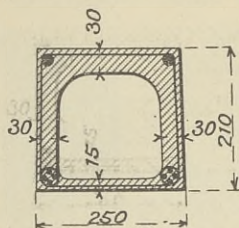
Coupe d'une poutre creuse, système Siegart.
